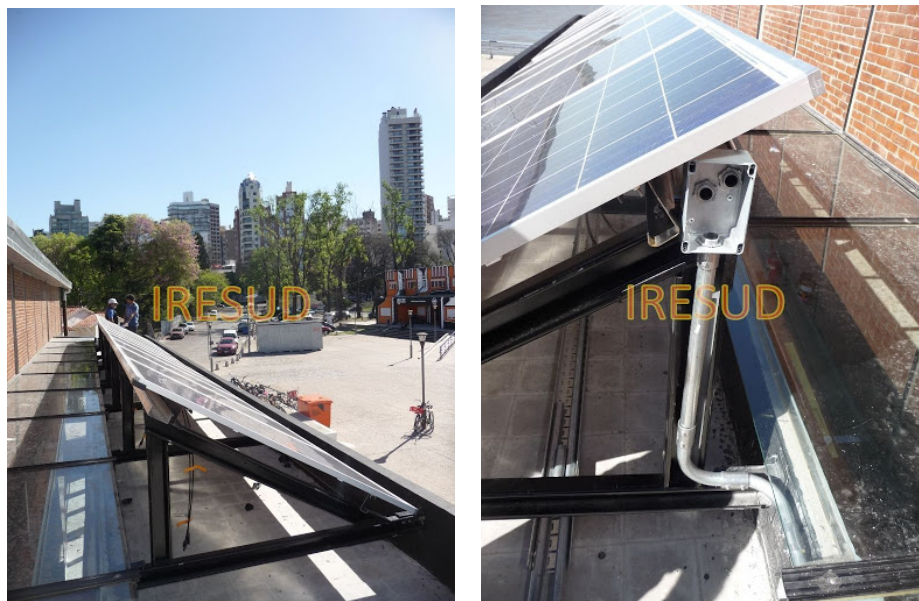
Detalle constructivo de la instalación fotovoltaica sobre cubierta (Iresud).
